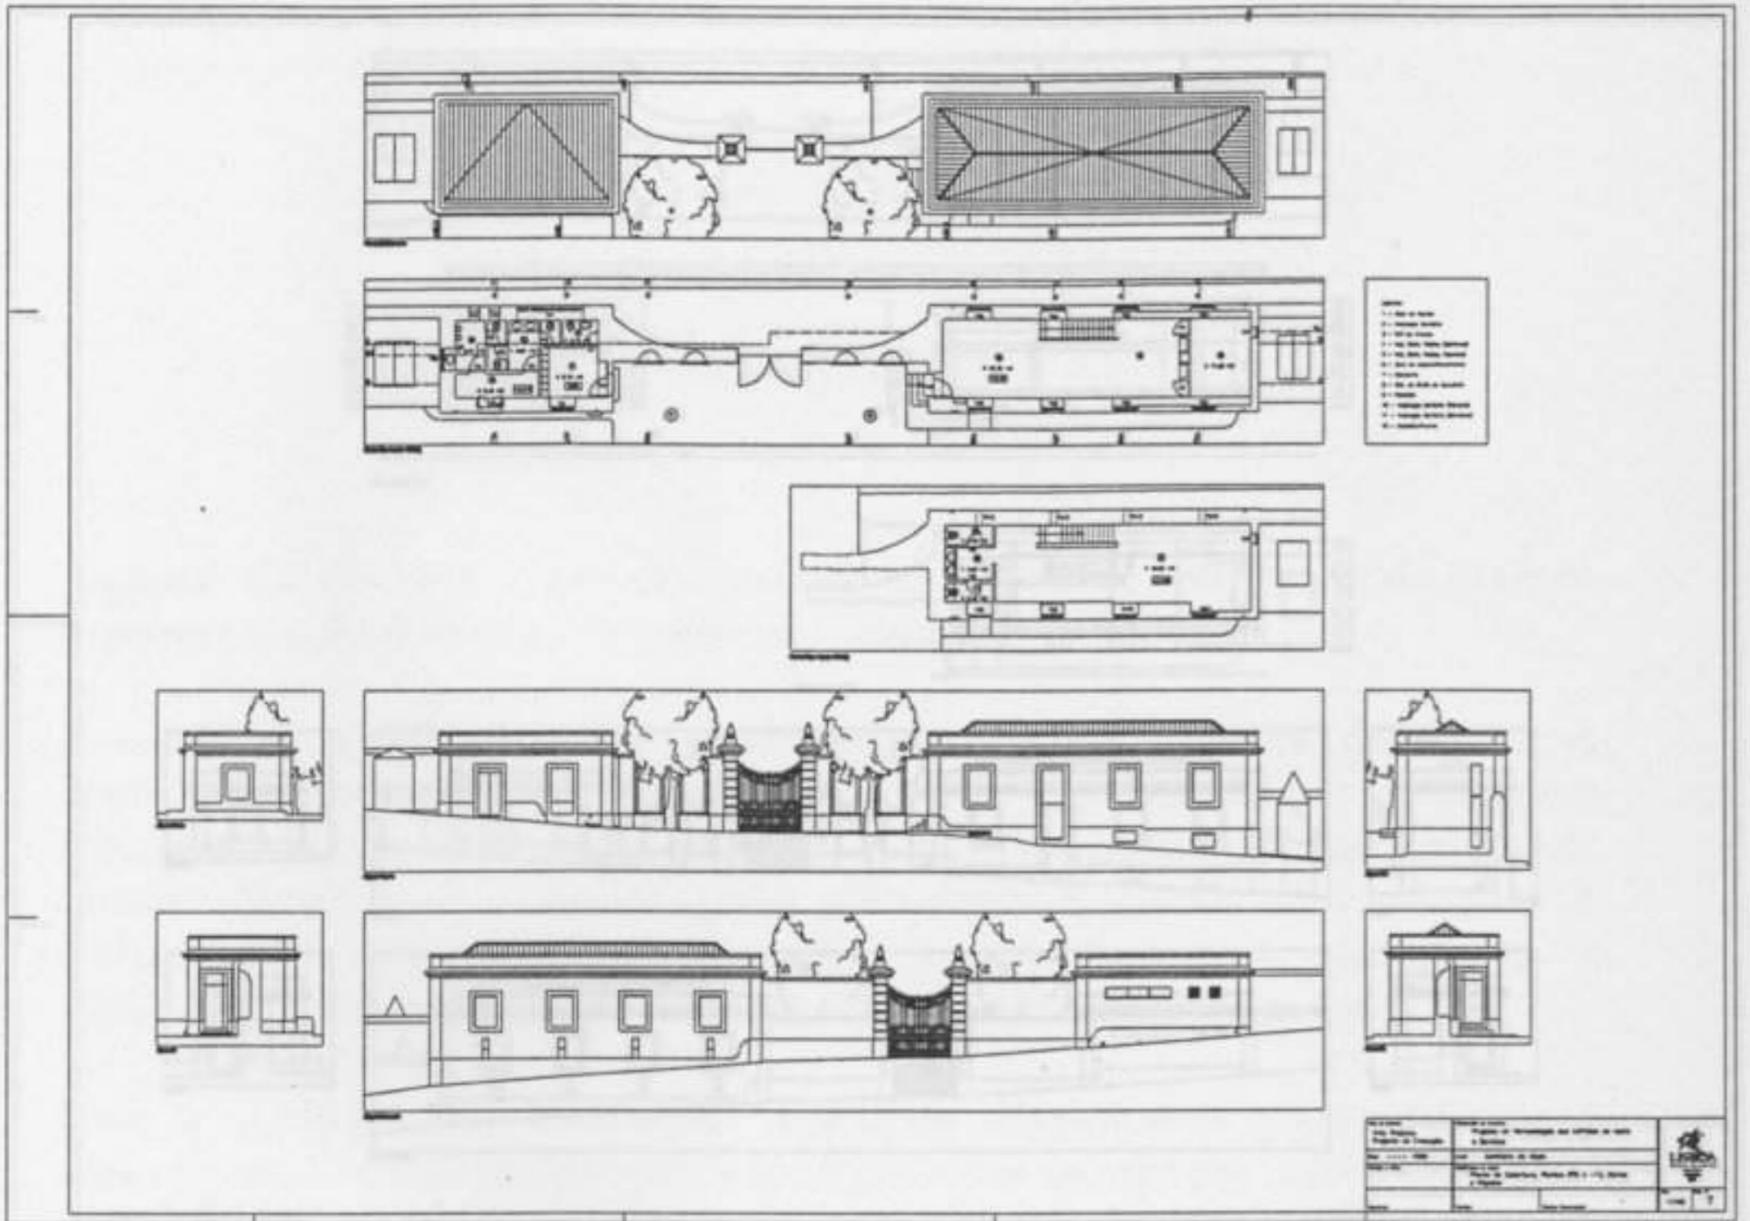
Ante-Projecto - Planta de Cobertura, Plantas e Alçados -
